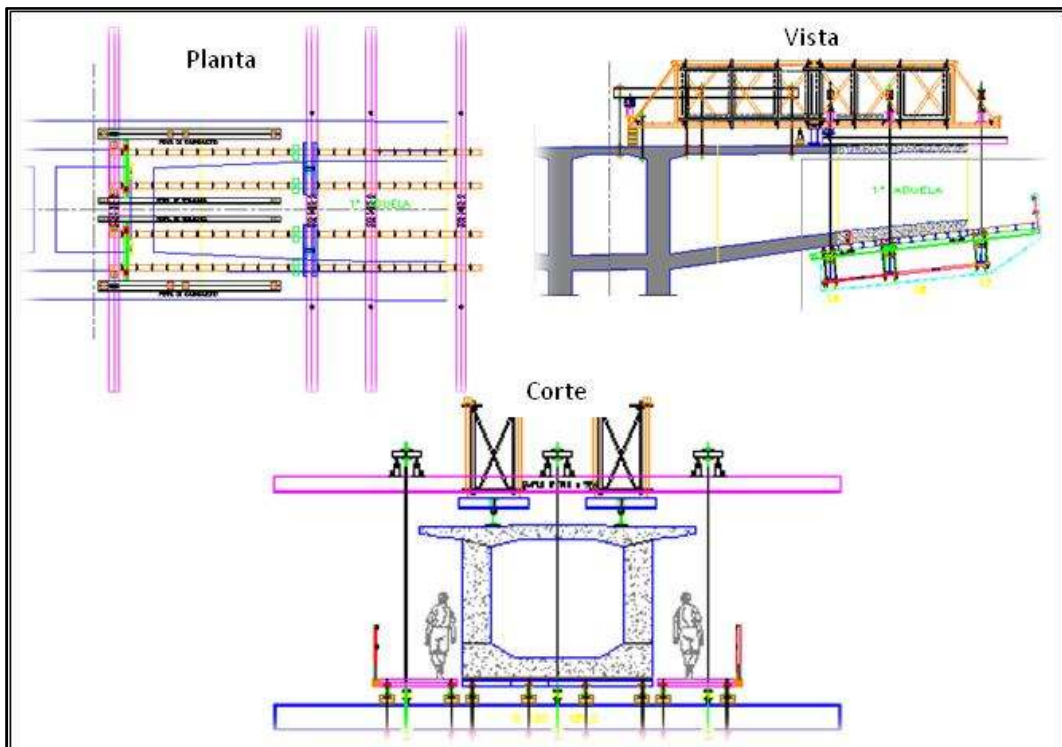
Esquema de planta, vista e corte referente ao Balanço Sucessivo com aduelas moldadas no local da obra do Rio Santa Luzia (M-150) Ferrovia Norte Sul – SPA Engenharia
